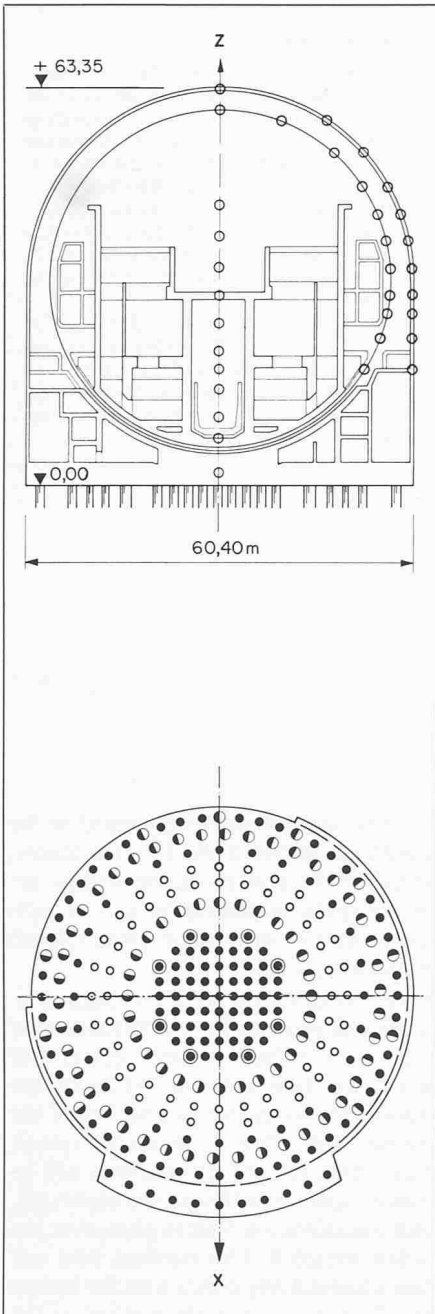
Reactorgebäude Angra 2. Ansicht und Grundriss mit der Lage der Pfähle
